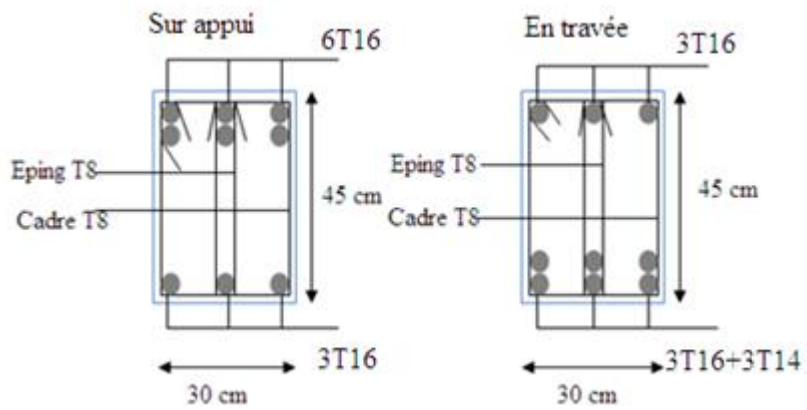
Ferrailage des P.P 7<sup>ème</sup> étage.
